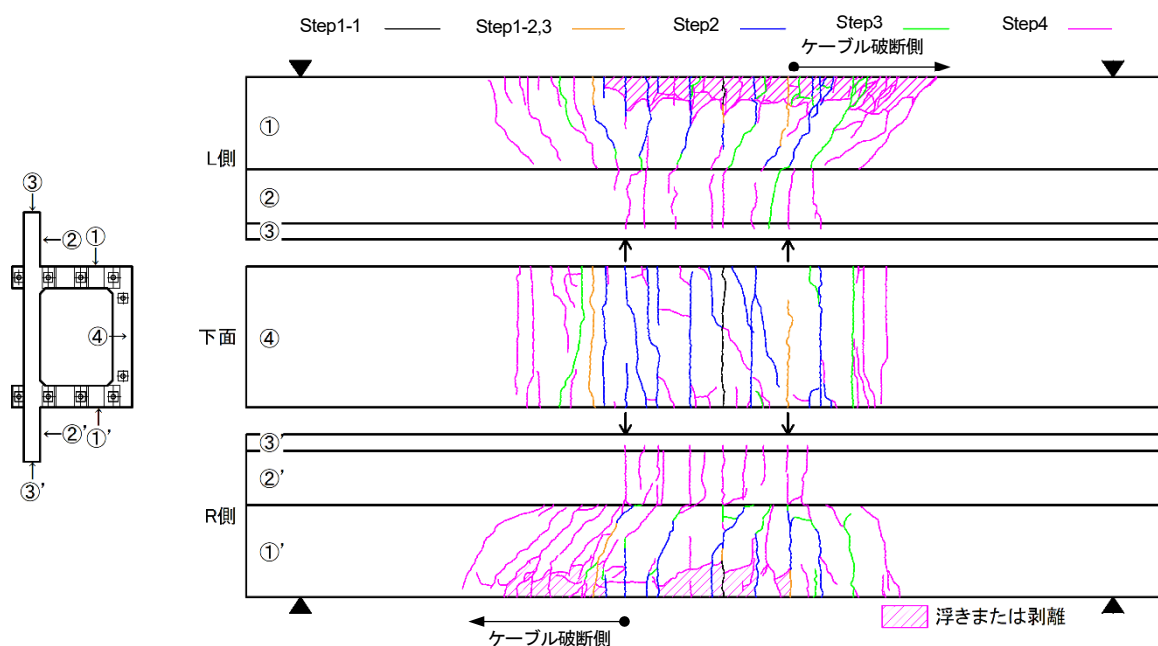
供試体のひび割れ状況 (供試体 G2)
